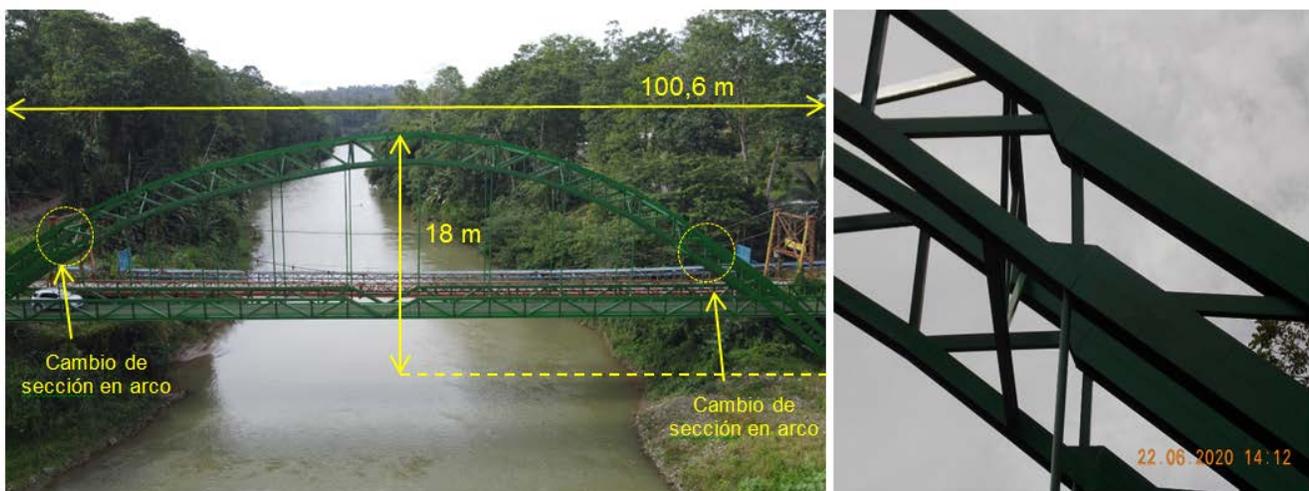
, Vista general del puente y detalle de cambio de sección en los arcos principales
